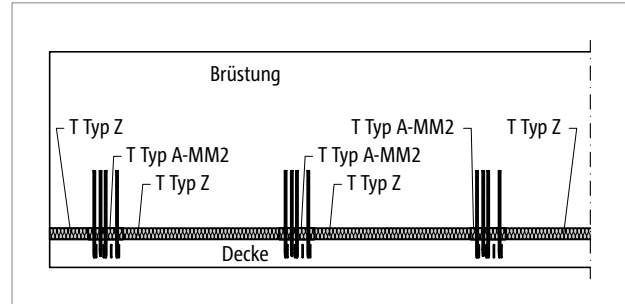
Schöck Isokorb® T Typ A, Z: Brüstung (T Typ A-MM2)
